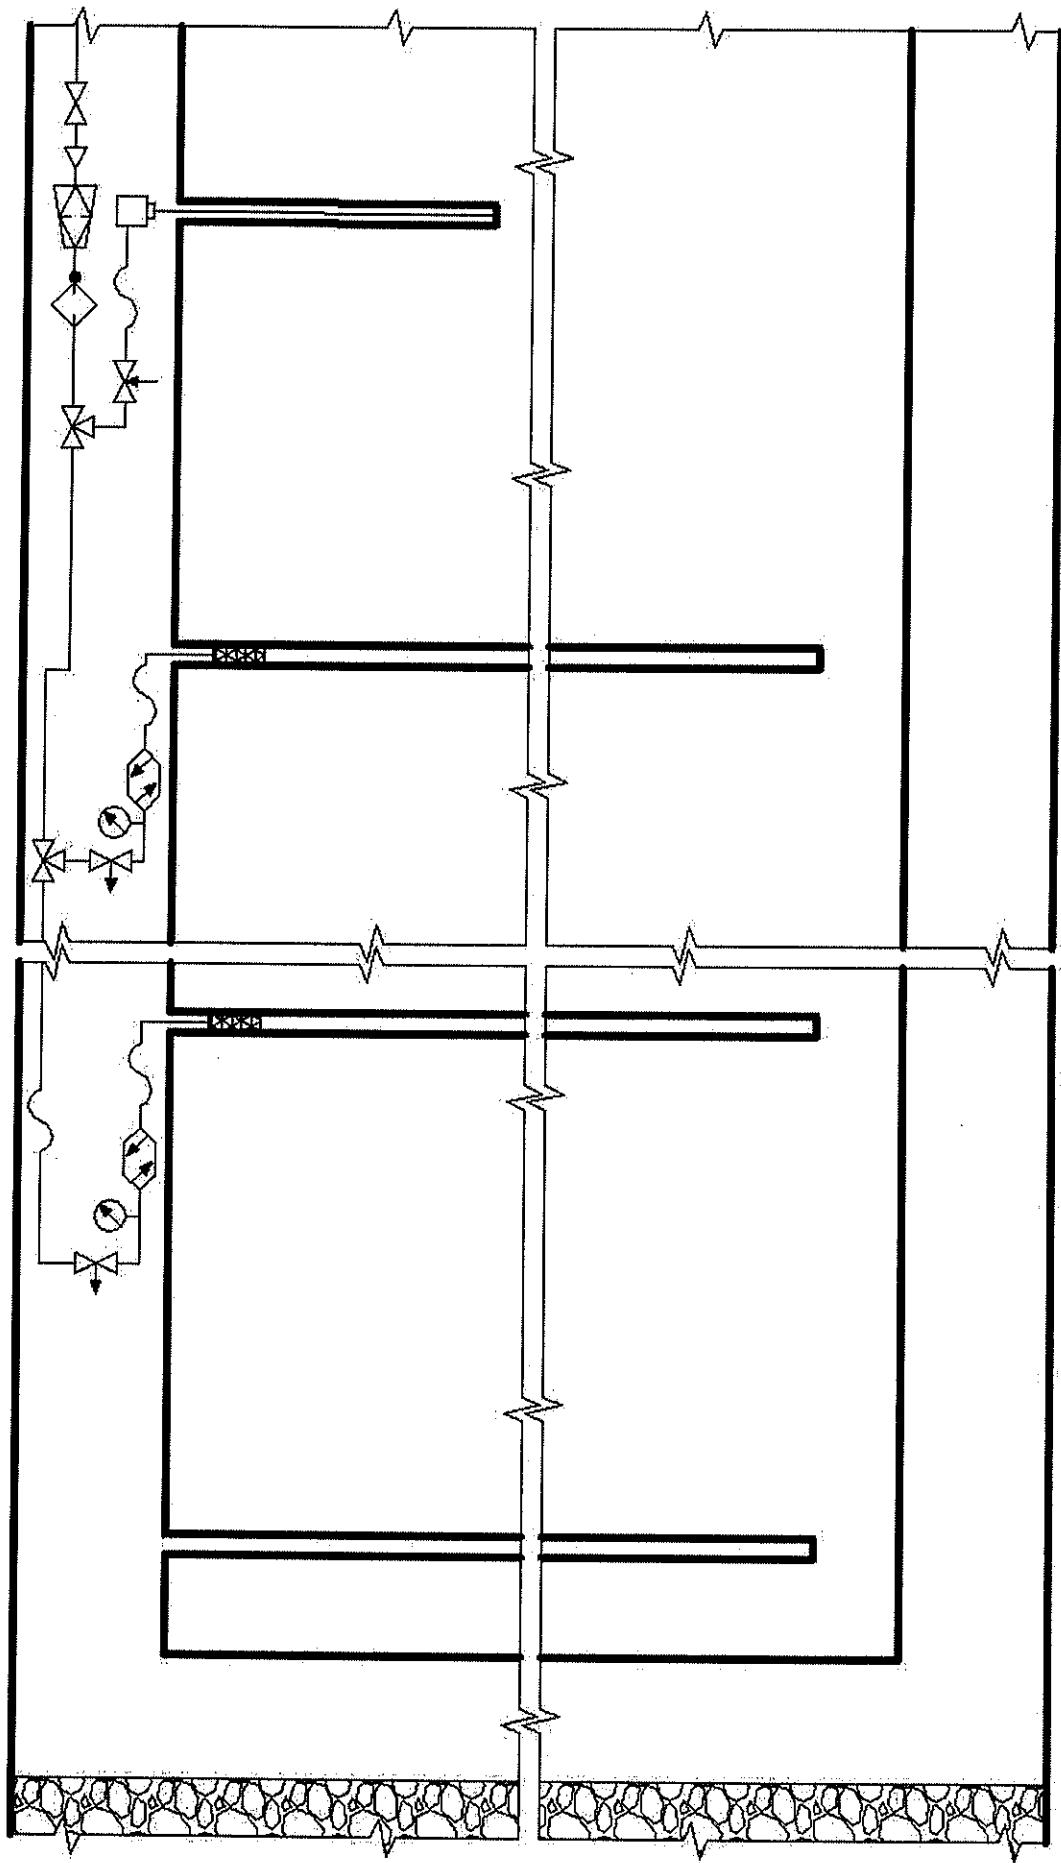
Технологическая схема нагнетания жидкости в угольный пласт из противопожарно-оросительного трубопровода через скважины, пробуренные из подготовительной горной выработки (схема 4)
